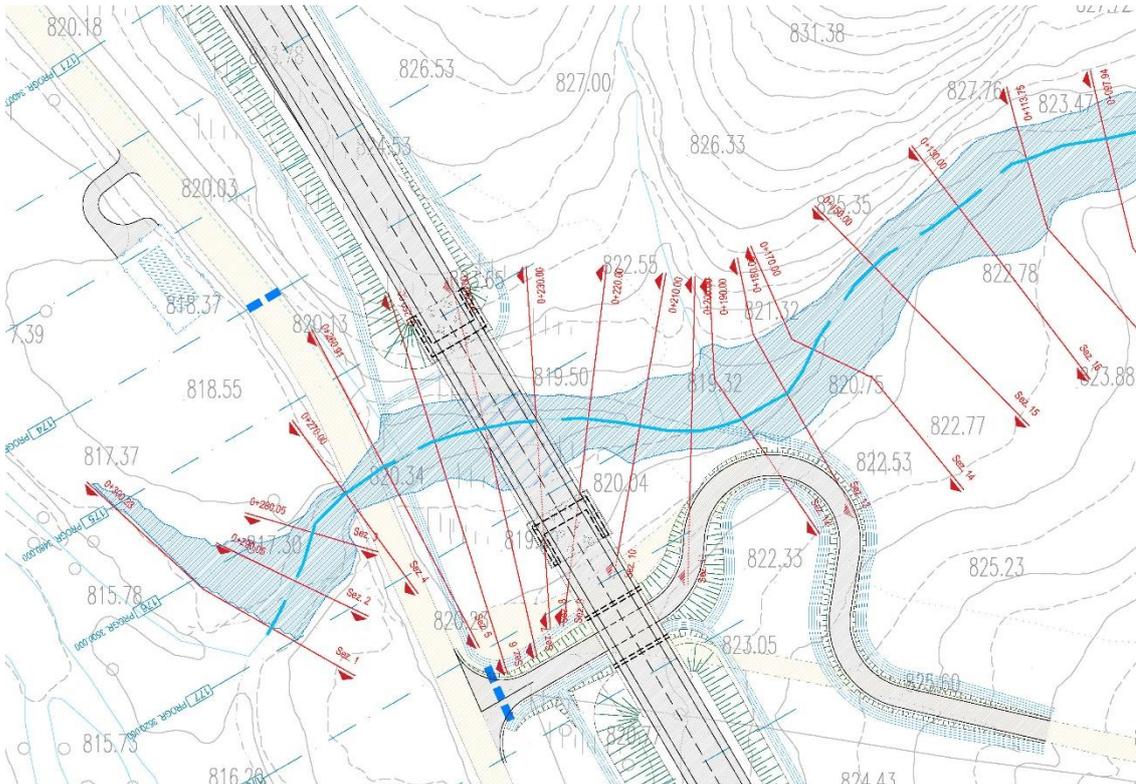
Riu Codula – Planimetria aree di esondazione.
